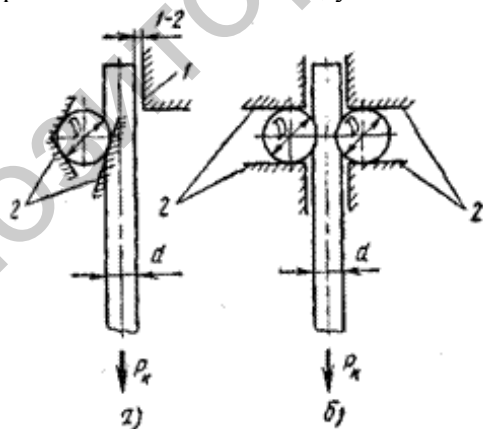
Схема испытания на срез крестообразных соединений арматуры; а — односрезное соединение, б — двухсрезное соединение;
